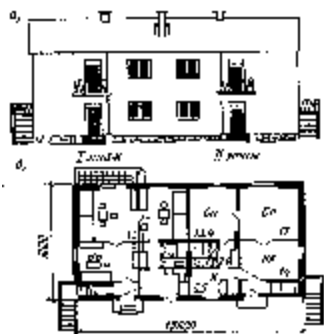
Четырехквартирный двухэтажный дом с трехкомнатными квартирами: а – фасад, б – планы этажей.
